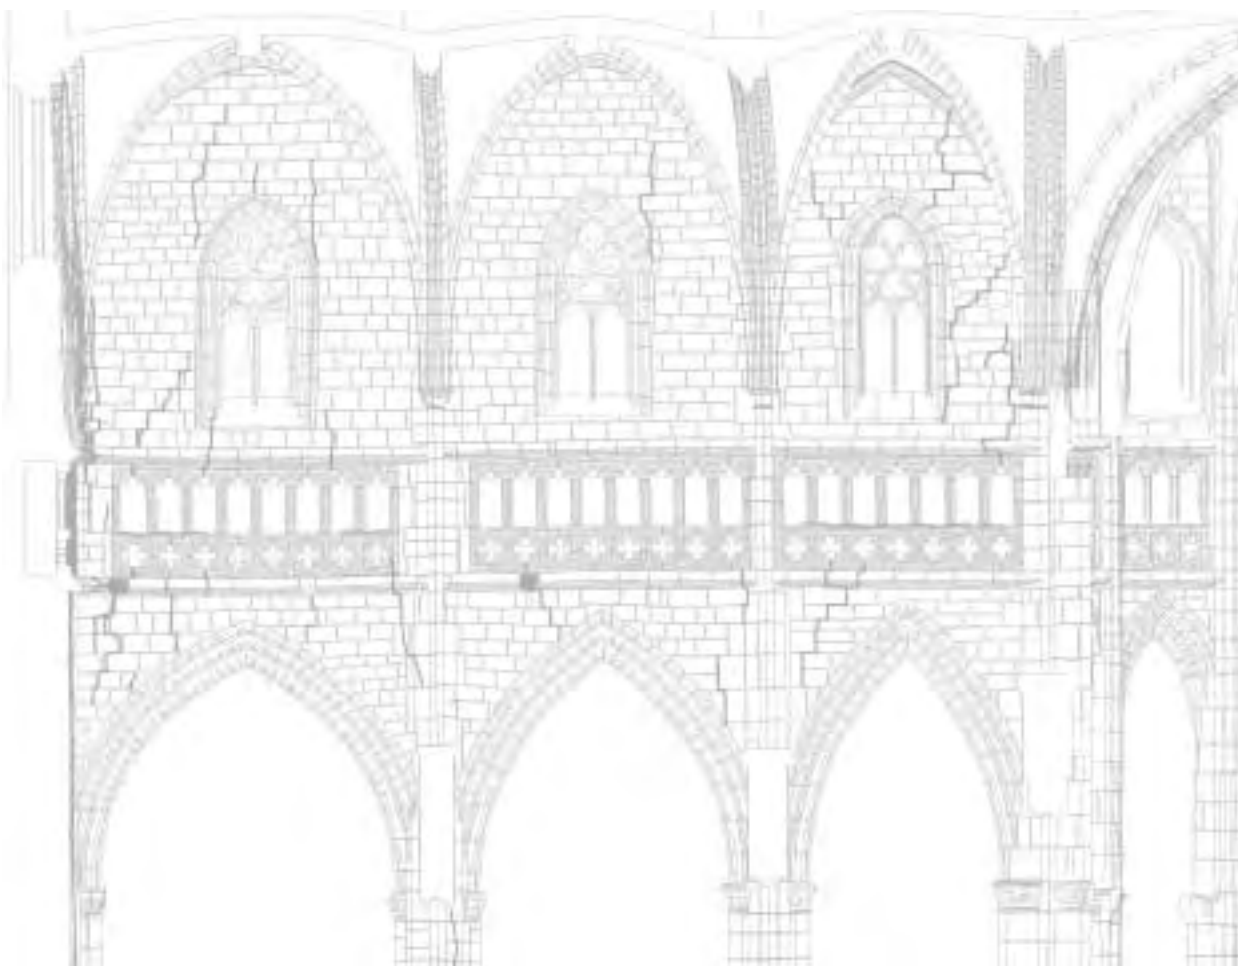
Sección del transepto hacia el este. Fisuras
